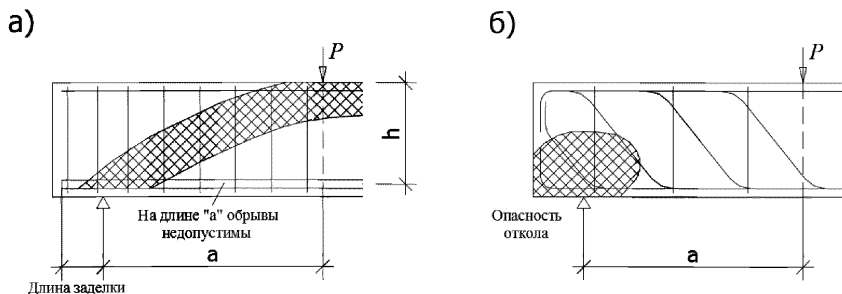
Схемы армирования опорных зон коротких балок:
